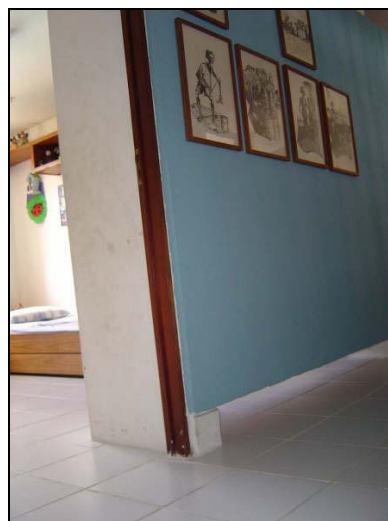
Casa U1.7 – Divisória entre os quartos e circulação solta do piso e do teto. Pavimento superior.
